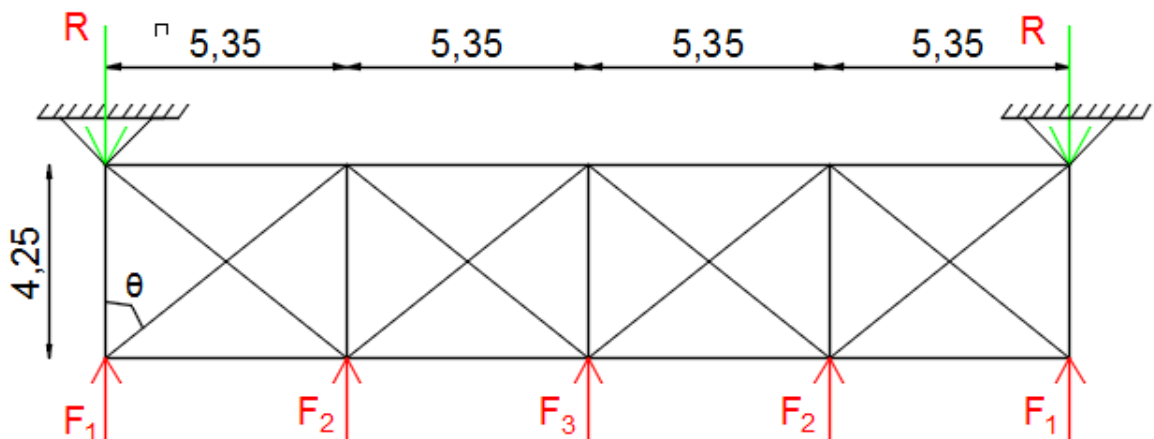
les forces horizontales et les réactions sur les poutres au vent
